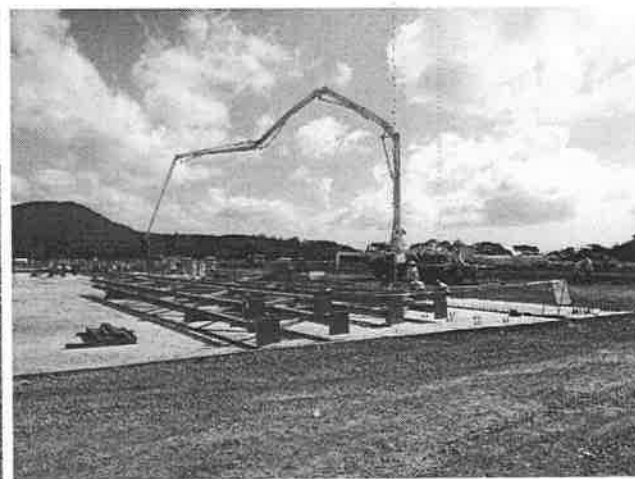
vaciado de cemento, por concretas, para la construcción de fundaciones y bases de estructuras físicas en el proyecto.
